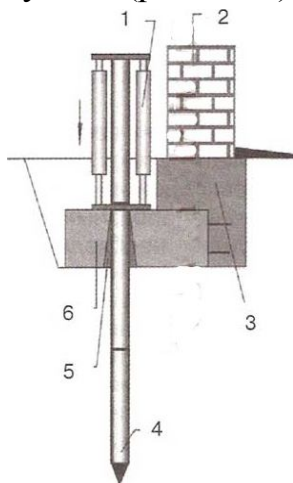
Схема посилення фундаменту з використанням залізобетонного ростверку:
